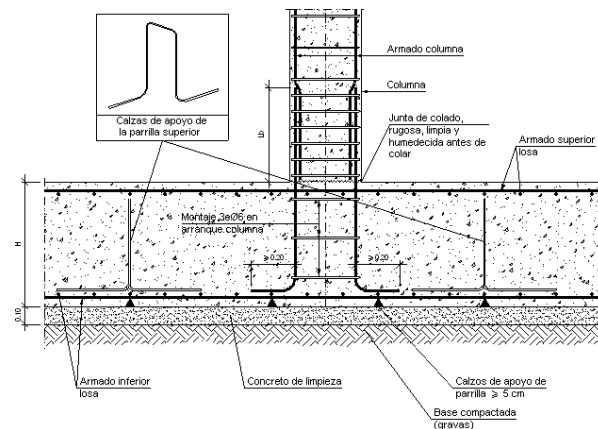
Detalle Arranque de Columnas. Fuente: <http://detallesconstructivos.mx.cype.com/CSL004.html> (2017).
